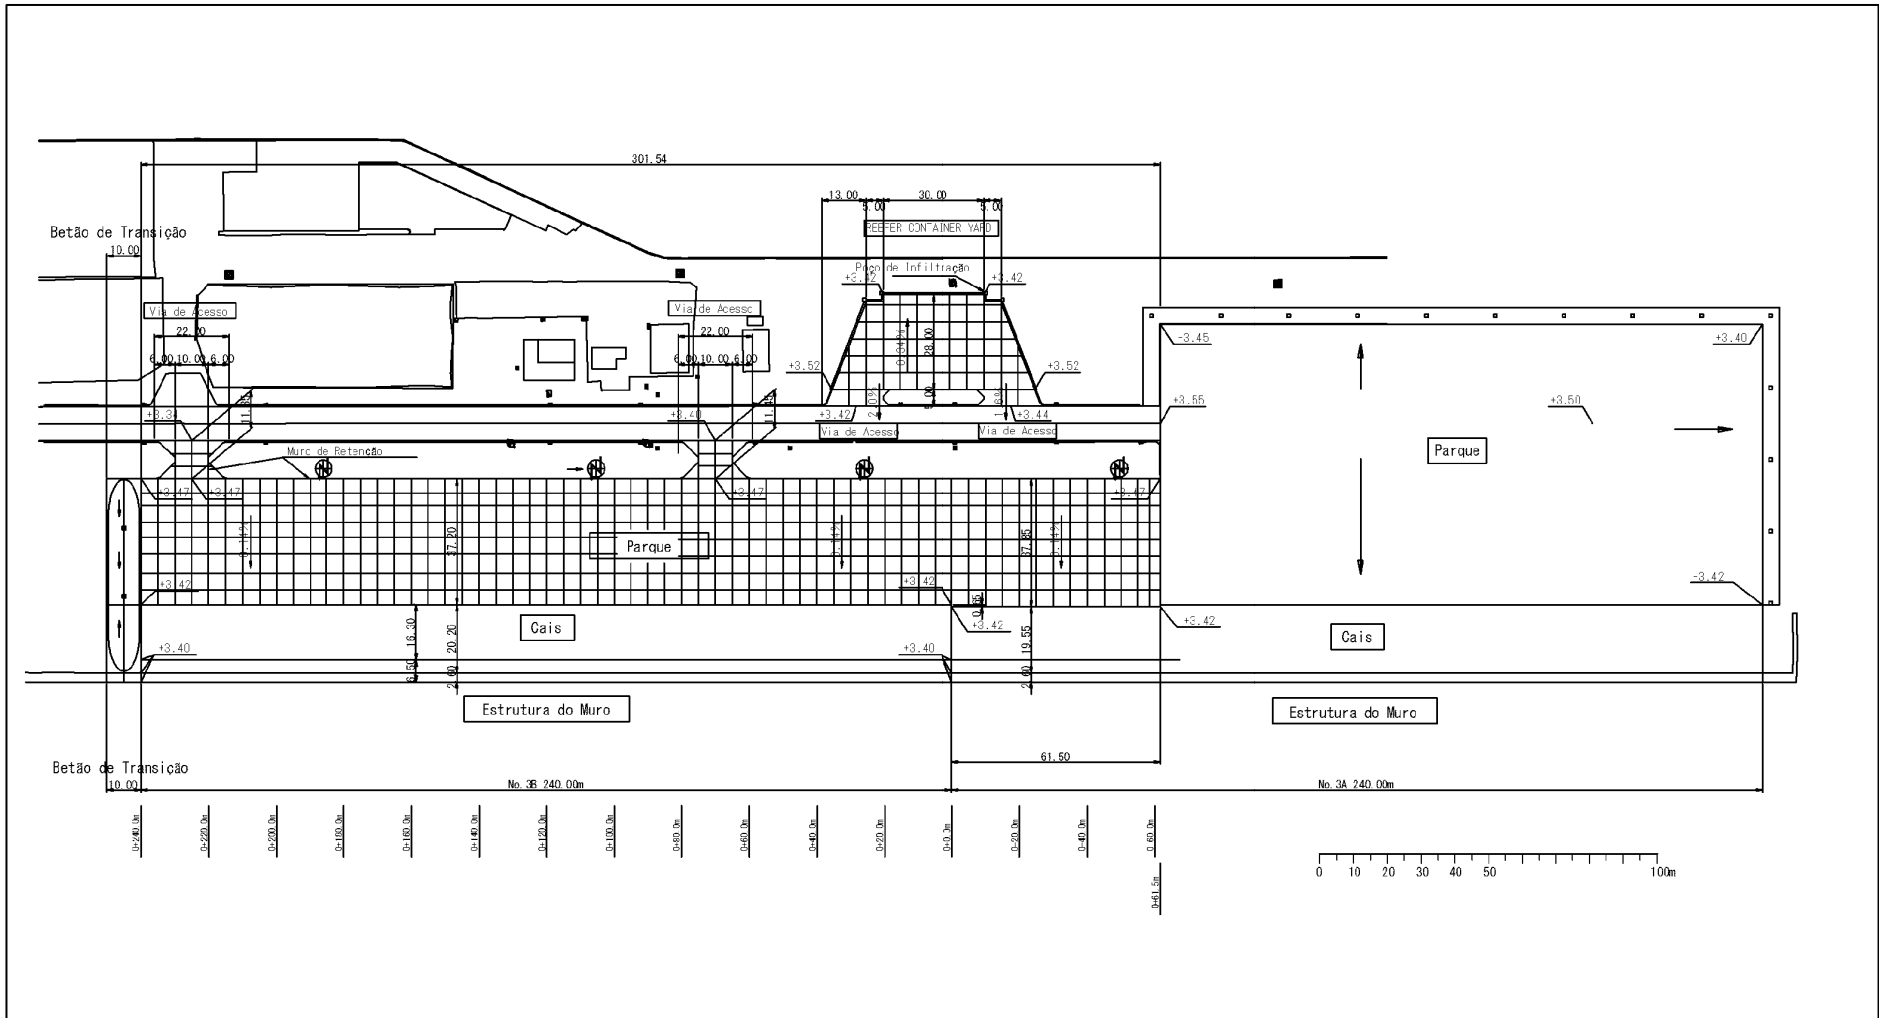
Planta Planimétrica da Pavimentação do Parque
